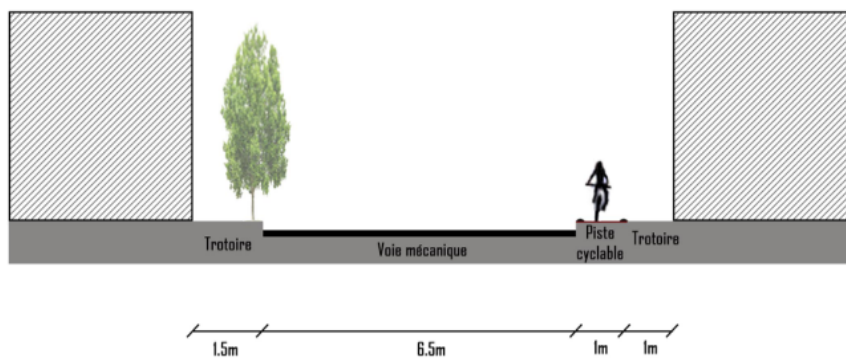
Vue en coupe de la voie secondaire (Auteur)
